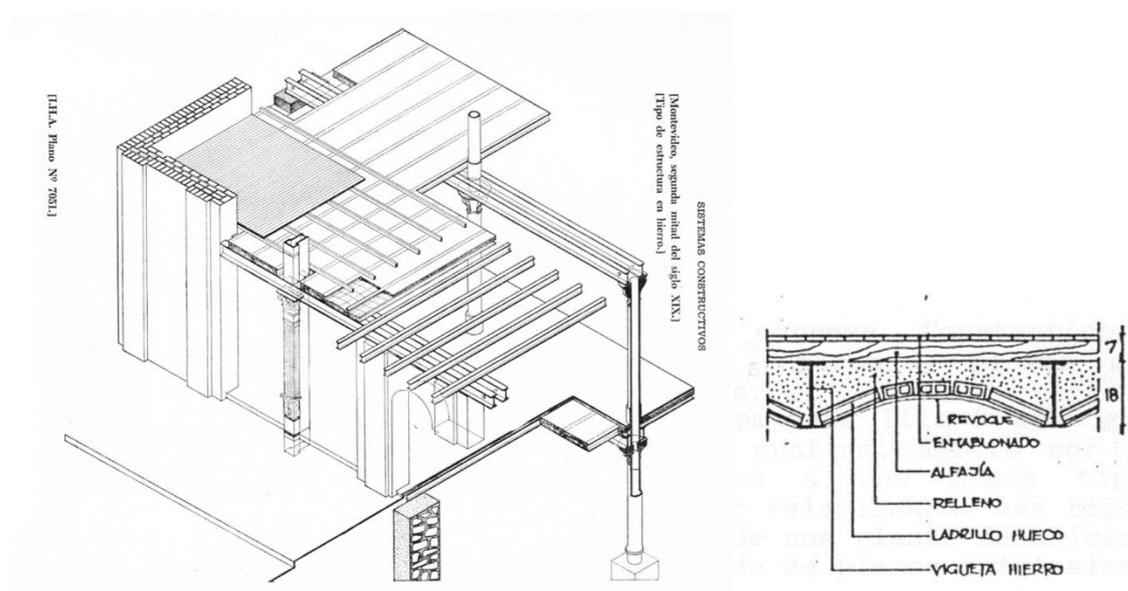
DETALLES CONSTRUCTIVOS, SISTEMA DE CUBIERTA A BOVEDILLA. ARCHIVO IH
